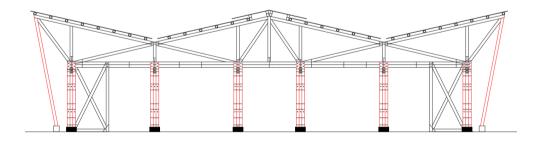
Secciones de Columnas en Vista Transversal. Fuente: [Propia]
